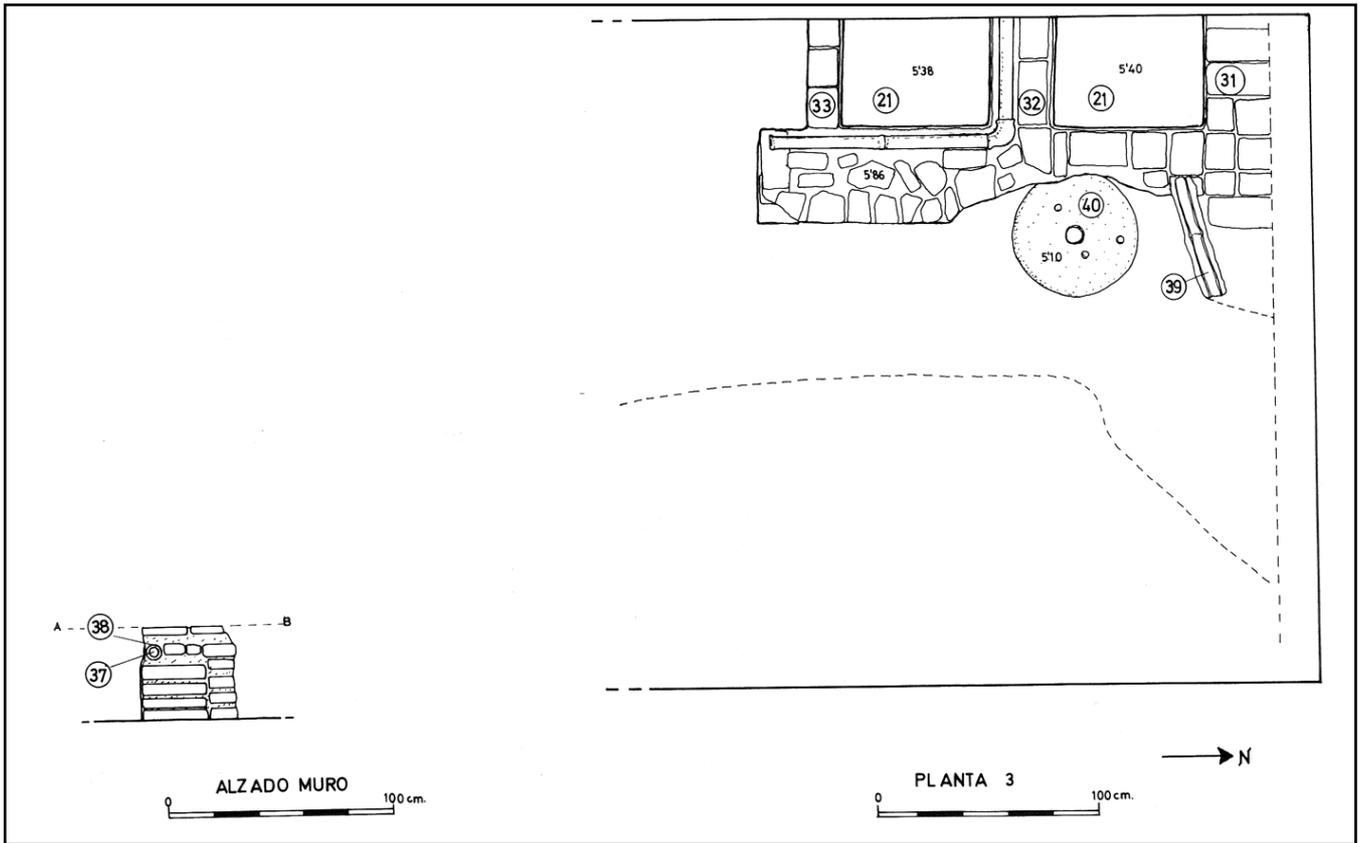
Cuadrícula 6. Planta y alzado de estructuras hidráulicas mudéjares.
